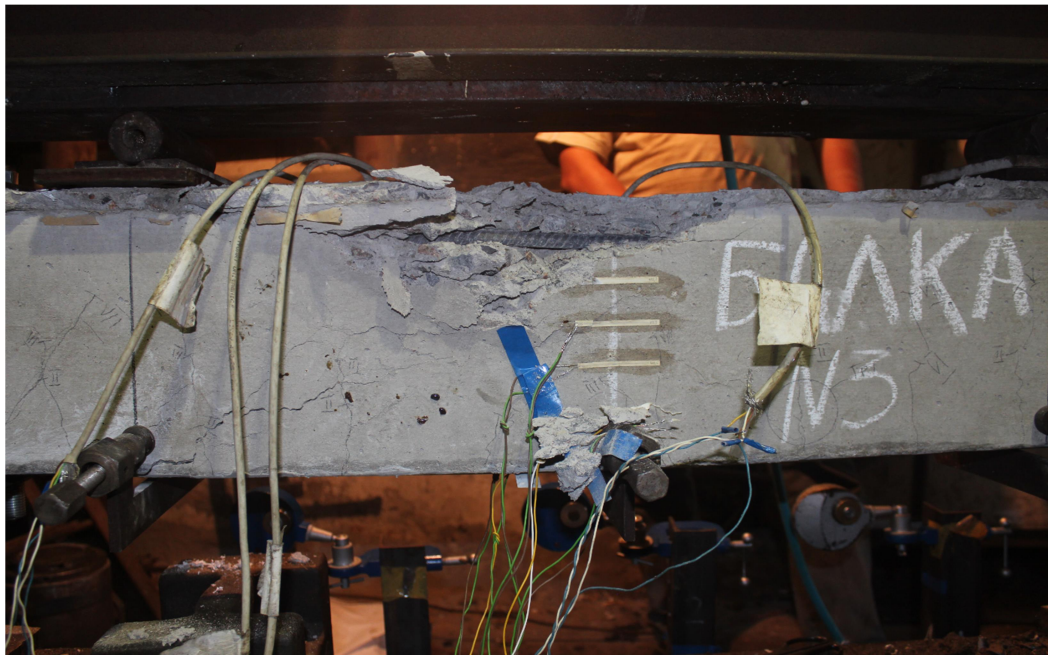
Разрушение усиленной балки в зоне чистого изгиба с разрушением сжатой зоны бетона
